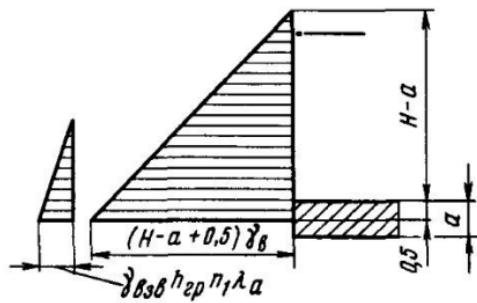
Схема для расчета стенок с одним ярусом креплений после укладки подводного бетона
